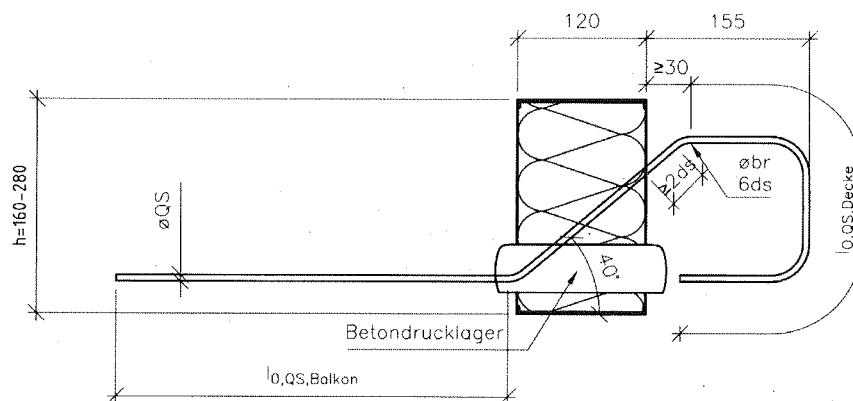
Elementschnitt ISOPRO® 120 – Q/QS Stabdurchmesser 6 – deckenseitig geschlauft Ausführung
